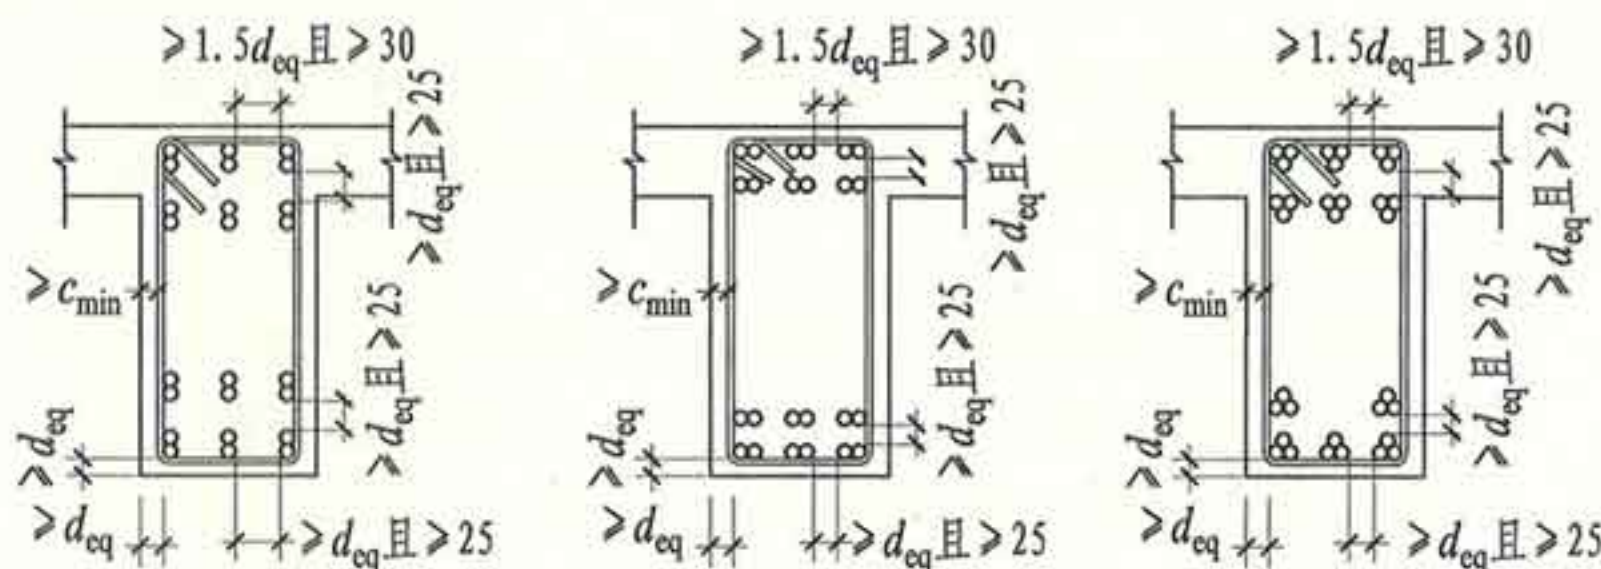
梁混凝土保护层厚度、钢筋间距要求示意图
